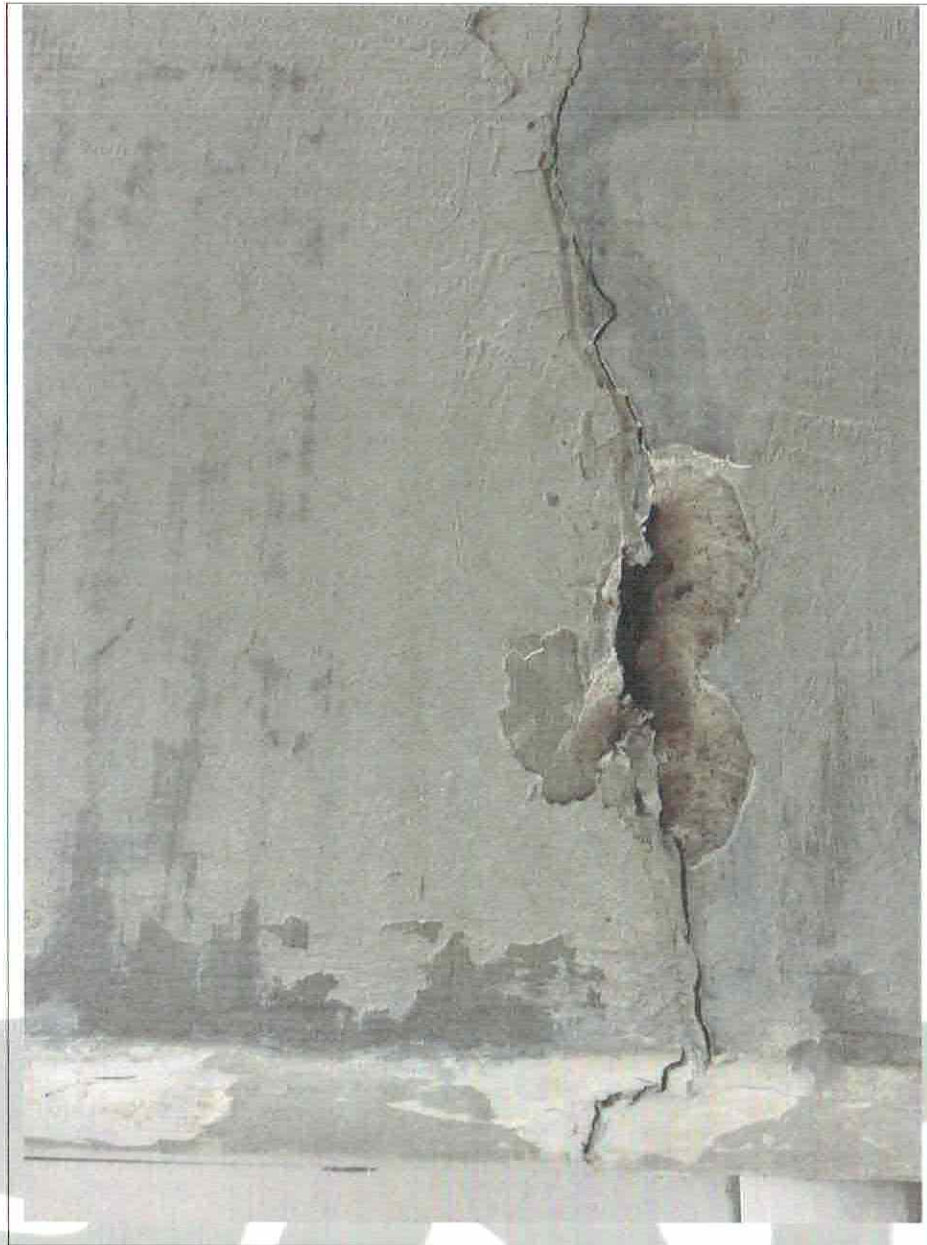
Trabe con falla por cortante en edificio de Sub Administración. Reparación sugerida en punto 4 del dictamen estructural.
